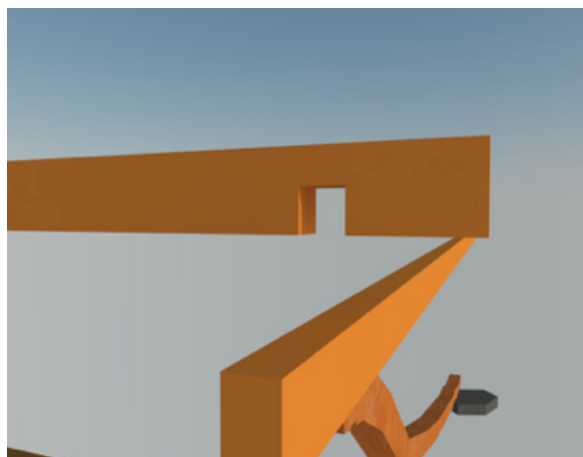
Struktur Bangunan Ehomu (Fondasi) Omo Sebua
